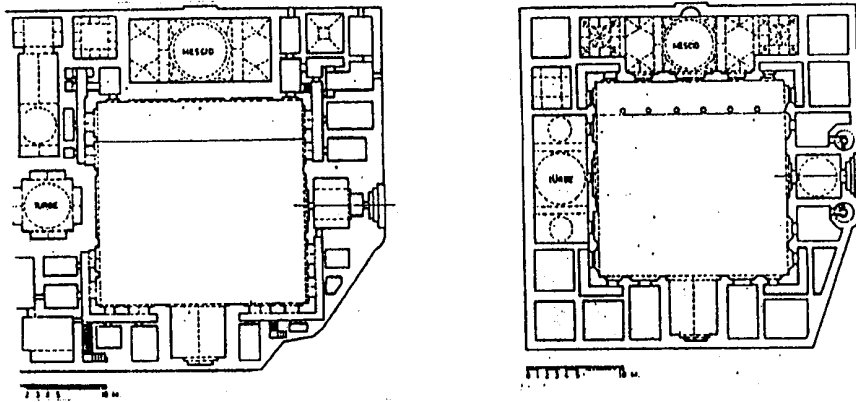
مسقط أفقي لمسجد رستم جلببي (كودوك منار)
